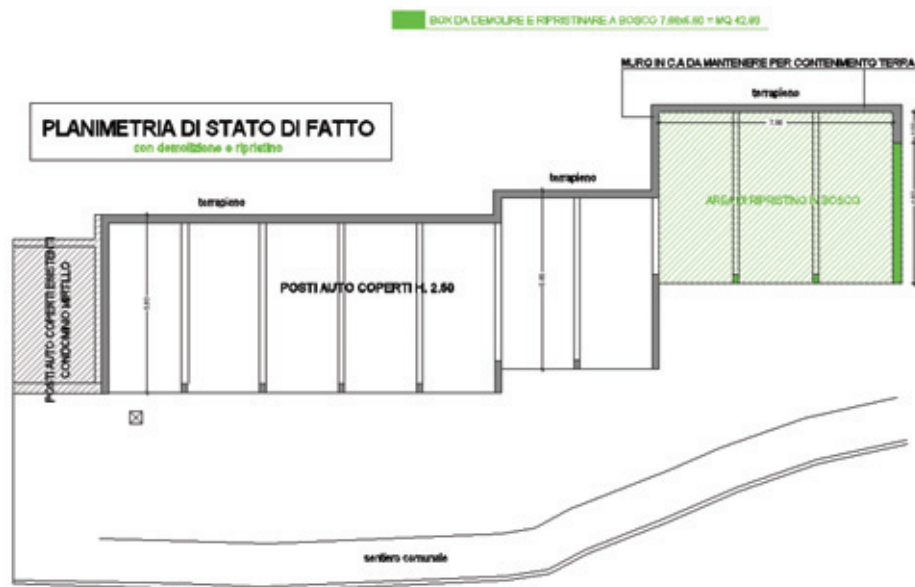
Planimetria e sezione con indicazioni intervento
